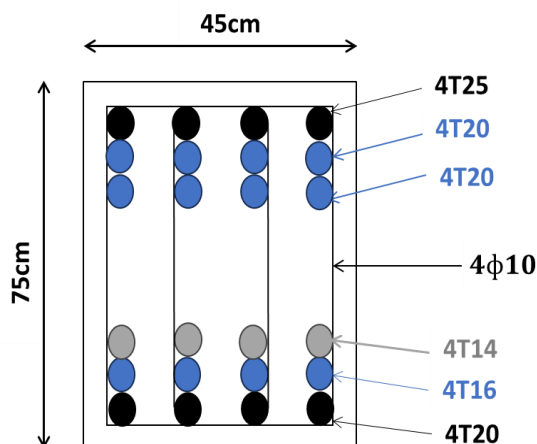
Ferrailage de la poutre de libage (sens transversale)
